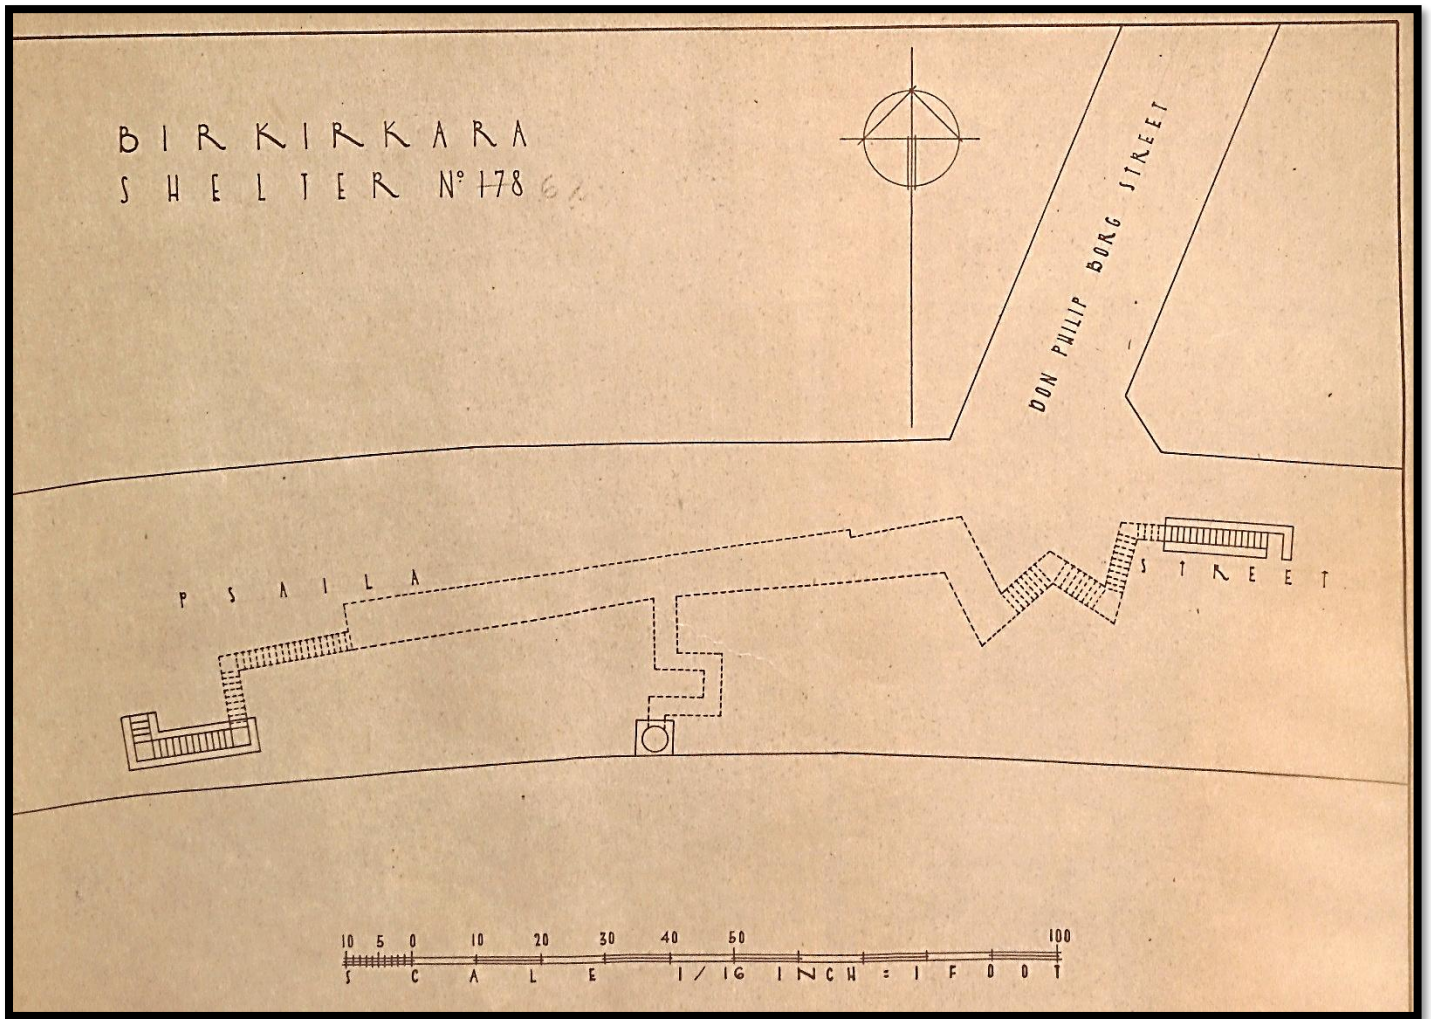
Planta do Abrigo nº 178 (62) "Psaila Street – Don Philip Borg Street."
